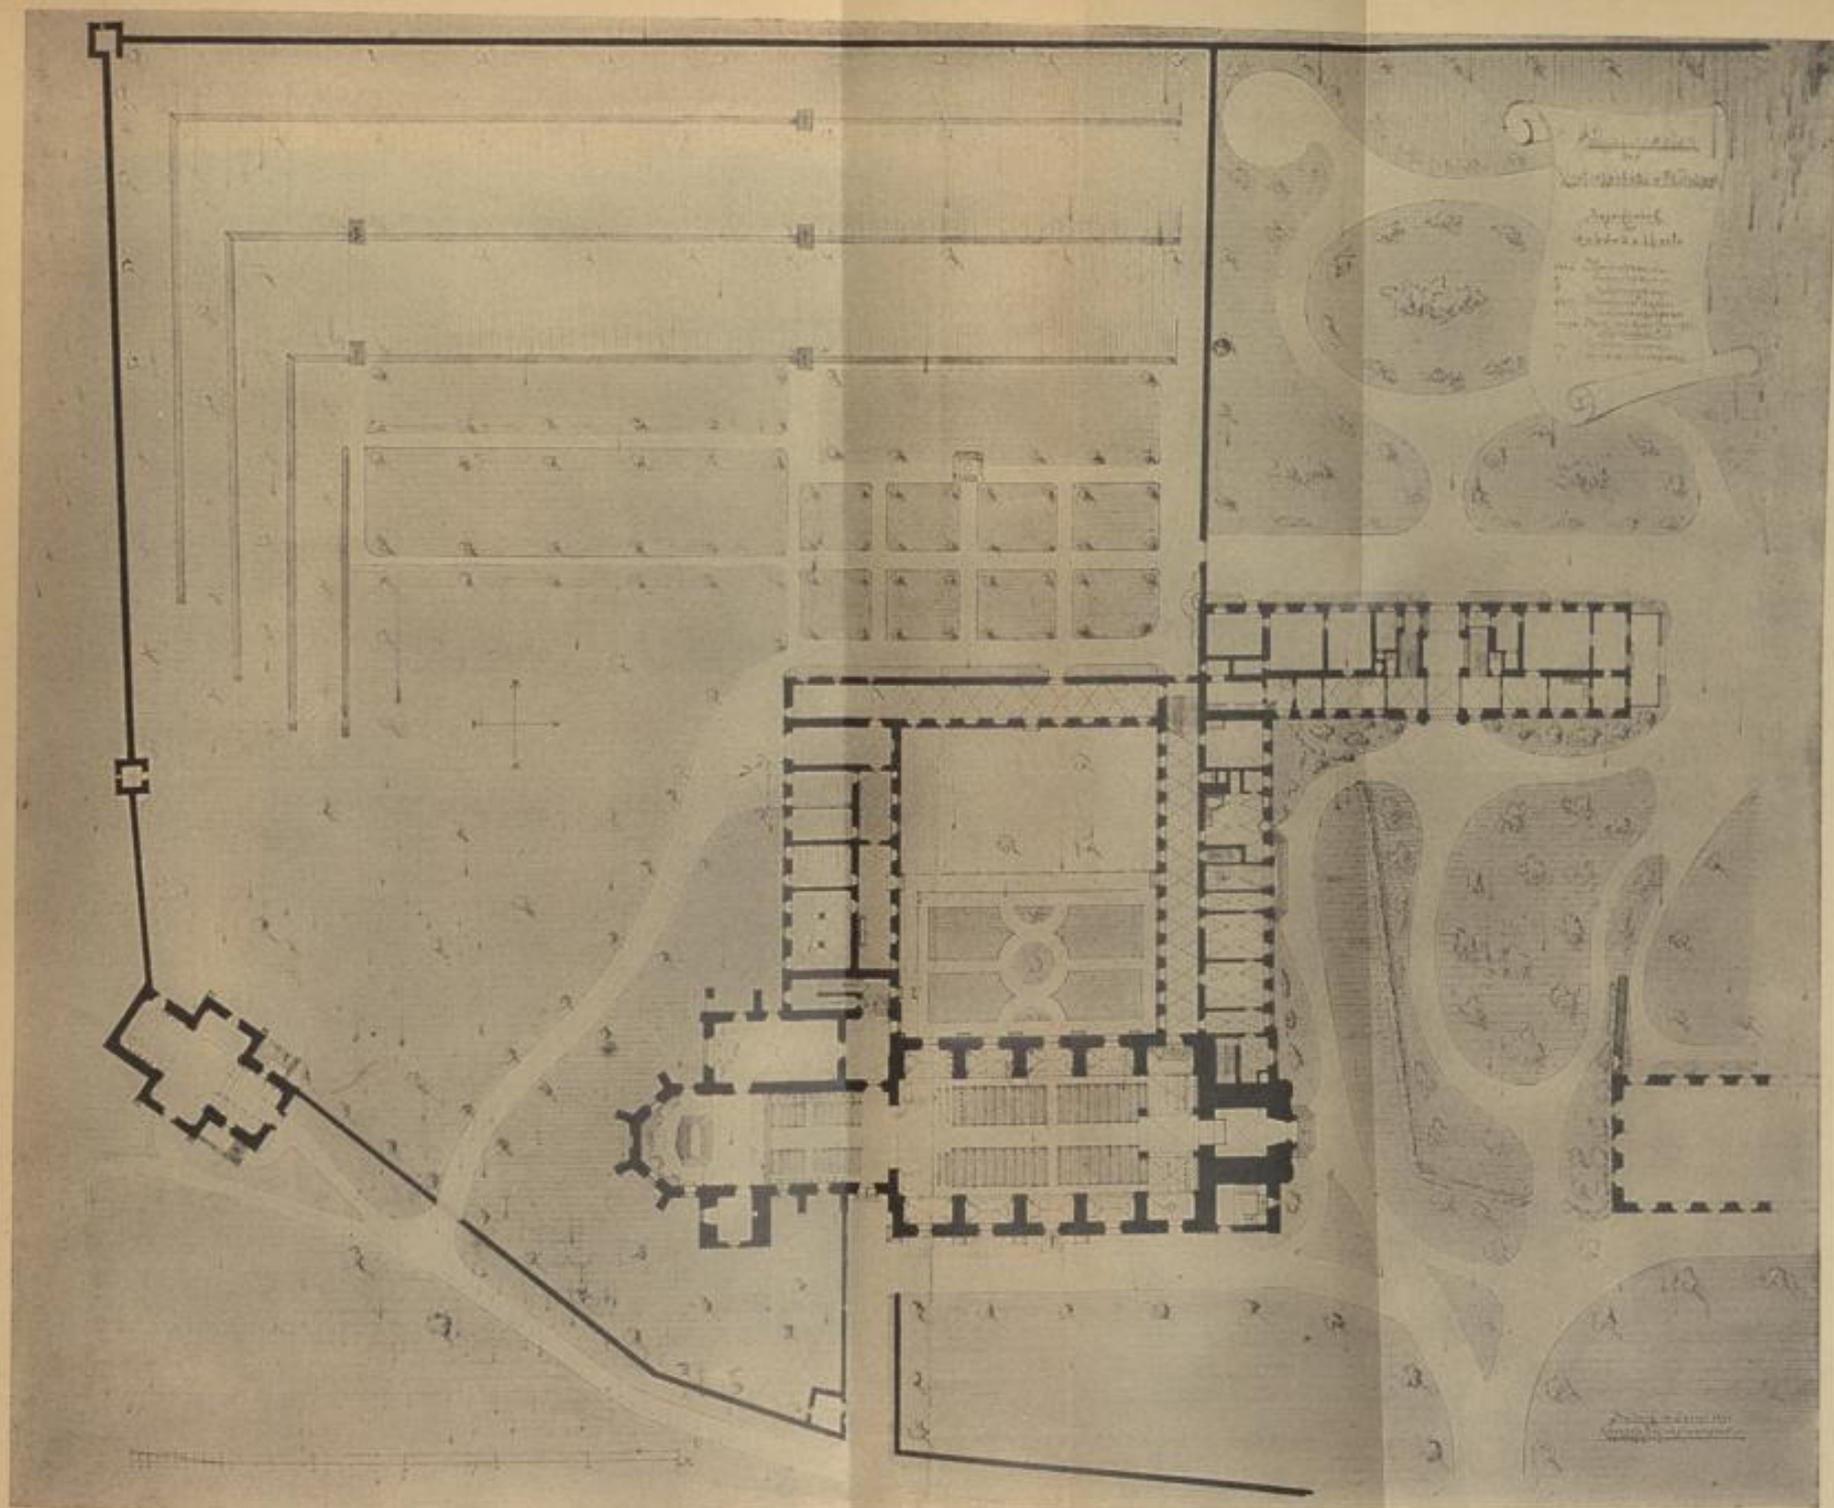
S. Trulpert. Grundriss des Klosters. (Nach einem Plan im Besitze der Grossh. Bezirksbauinspektion zu Freiburg.)
